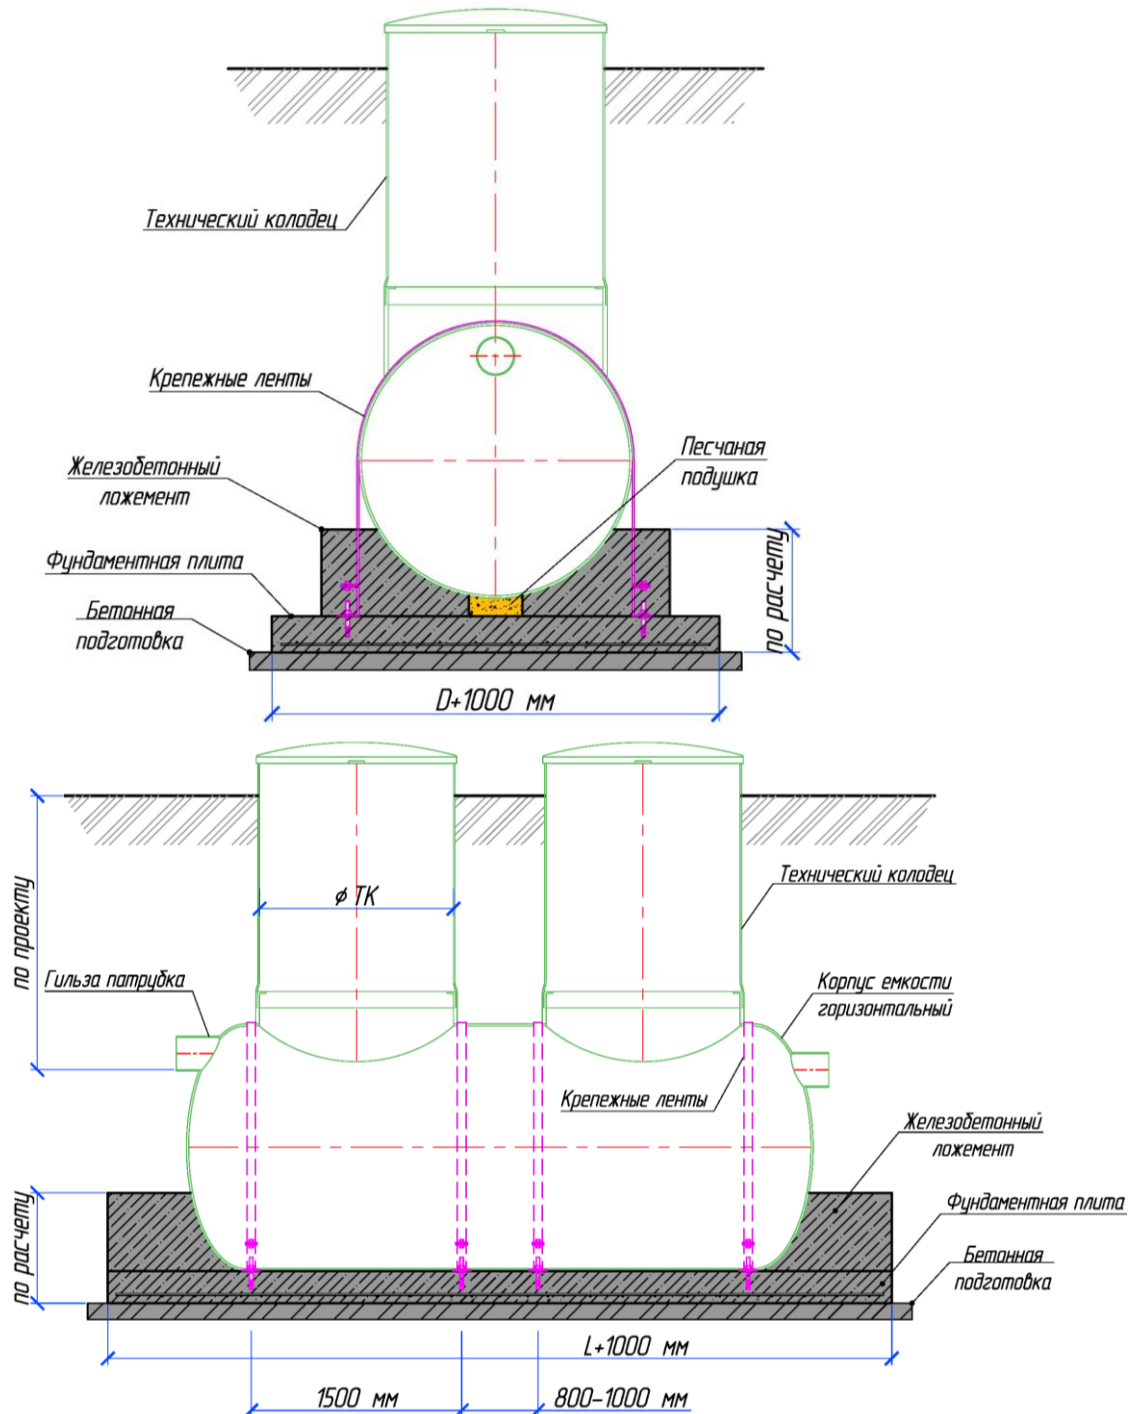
Крепление горизонтального изделия к фундаментной ж/б плите
